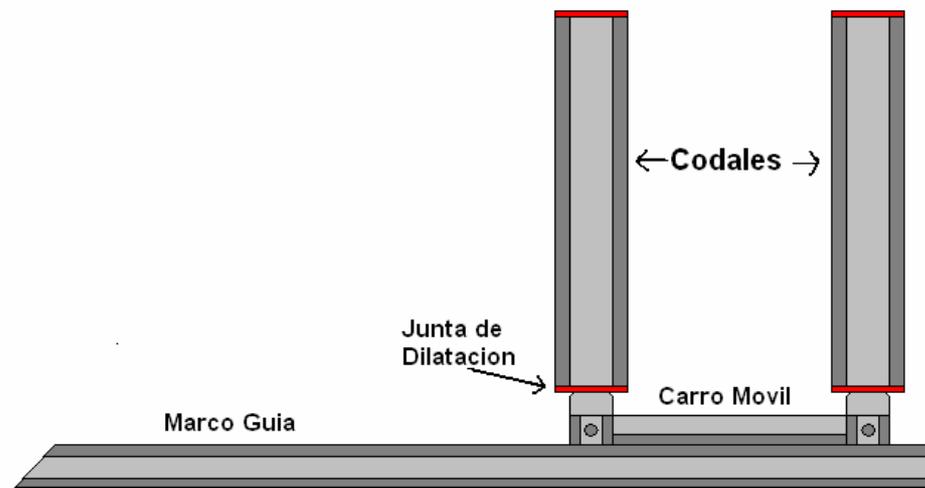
Montaje vertical de los Codales. (Perfiles en H para el Sistema Paralelo y Codales regulables para el Sistema de Doble Corredera. /Elaboración Propia.
